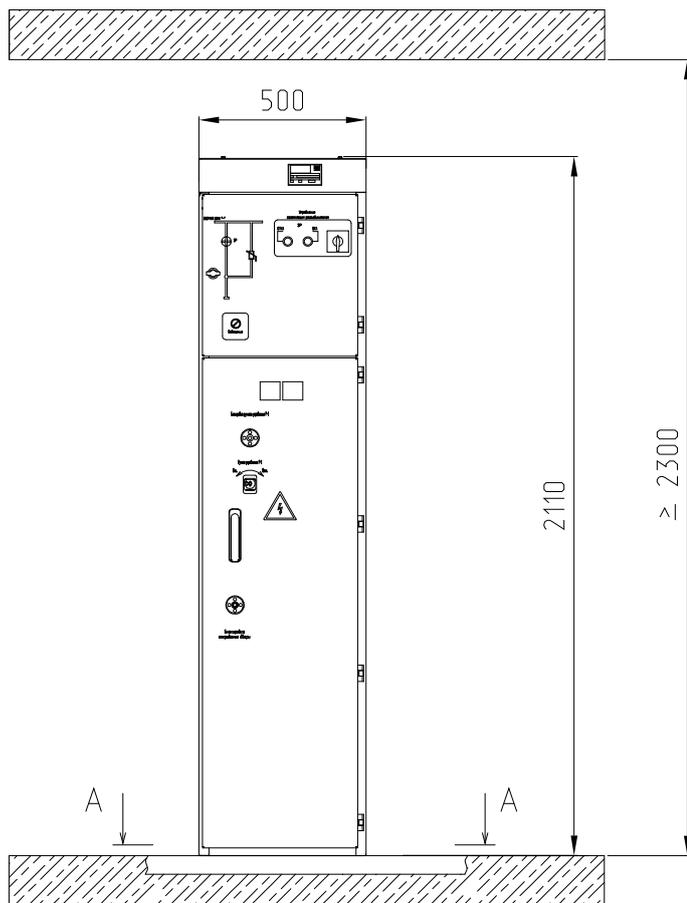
Ячейка линейного разъединителя РУОШ-600-ЛР-3-УХЛ4
